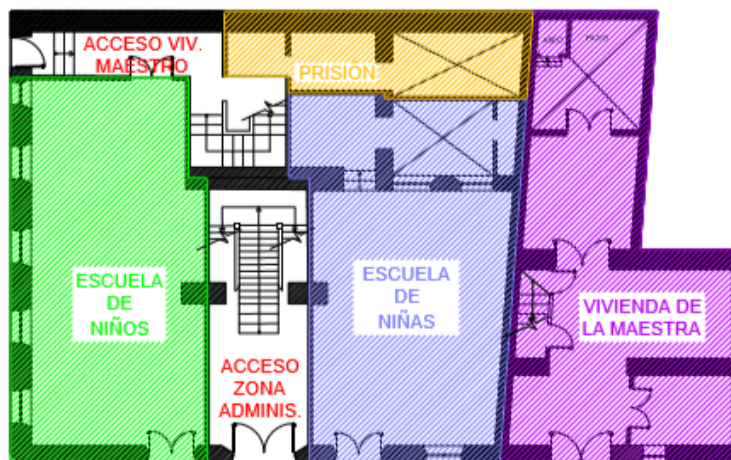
Plano división de usos. Planta baja. Fuente: elaboración propia, creación 20/06/2019
